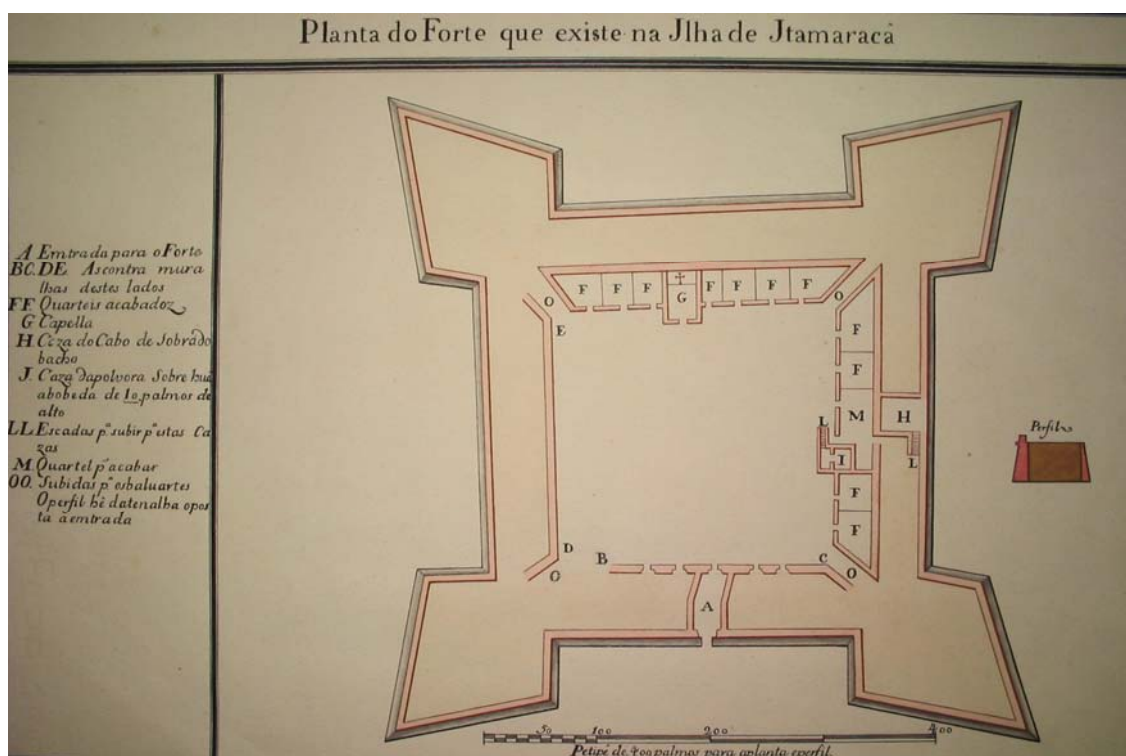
Planta do Forte que existe na Ilha de Itamaracá. Ano 1763. AHU
